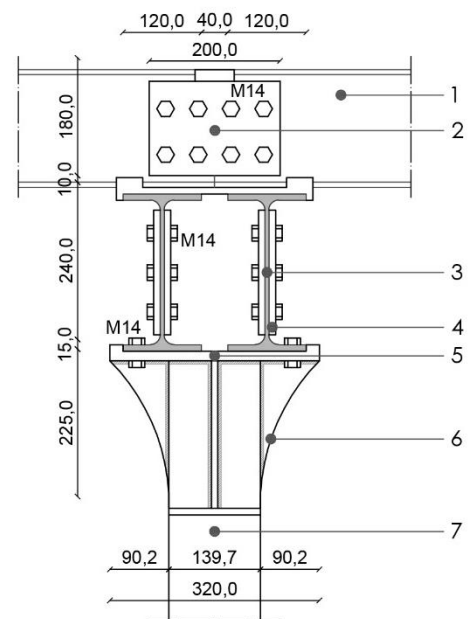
Dettaglio stato di fatto n. 2:
